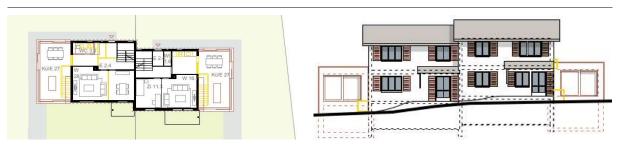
Grundriss mit Anbau seitlich
